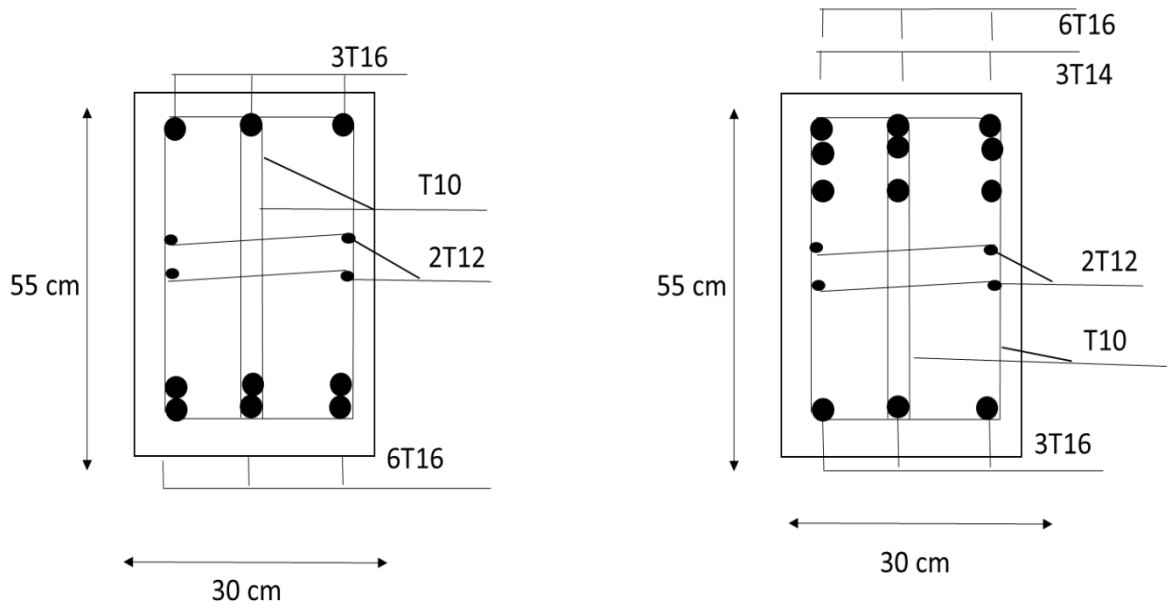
Schéma de ferraillage de poutre principale 30x55 (habitation).
